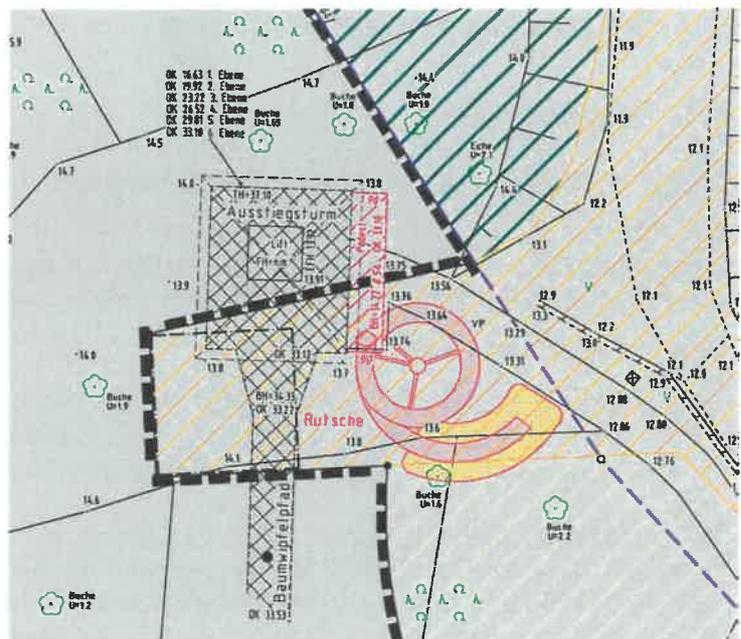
Lageplan Bestand Ausstiegsturm mit Planung und Geltungsbereich Ursprungsplan
